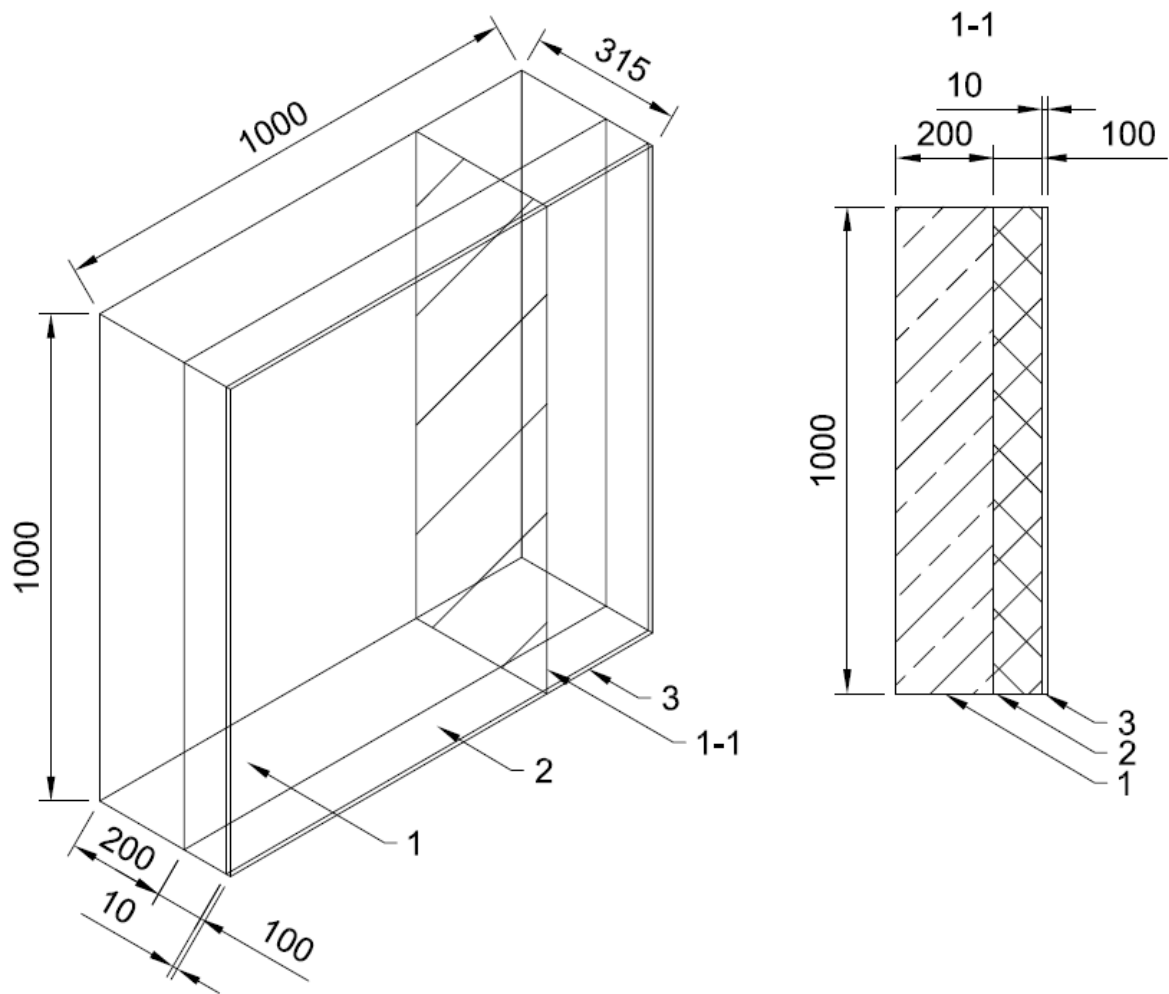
Теплоізоляційна стіна та її поперечний розріз 1-1: 1 – основний масив стіни з пінополістиролбетону; 2 – утеплювач; 3 – зовнішній огорожуючий шар (клейовий розчин з армувальною сіткою)
